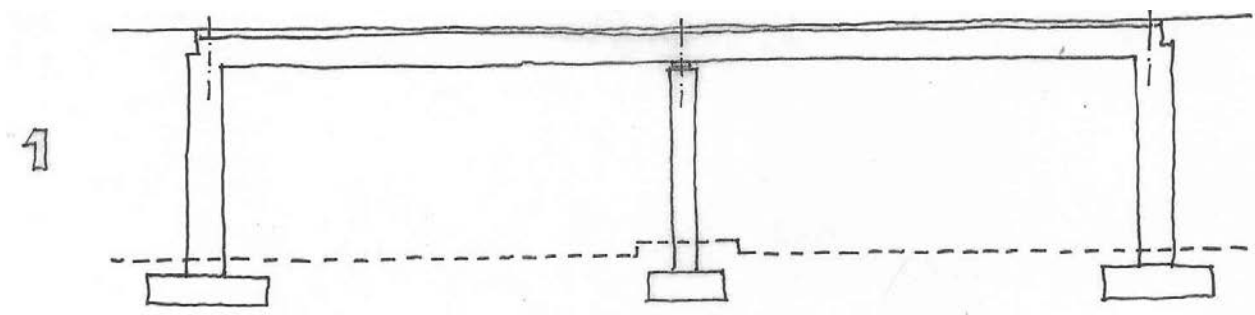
Puentes cortos con estribos activos sísmicamente, para las fuerzas inerciales del tablero
